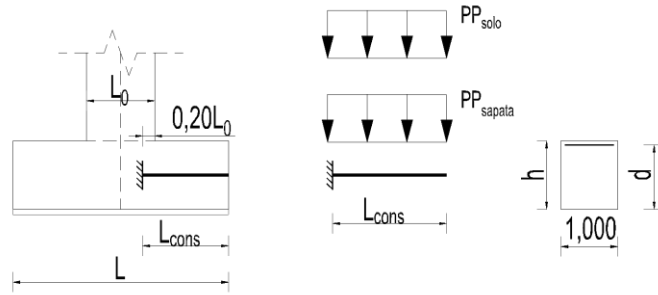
Modelo de cálculo das armaduras da face superior na direção Y
